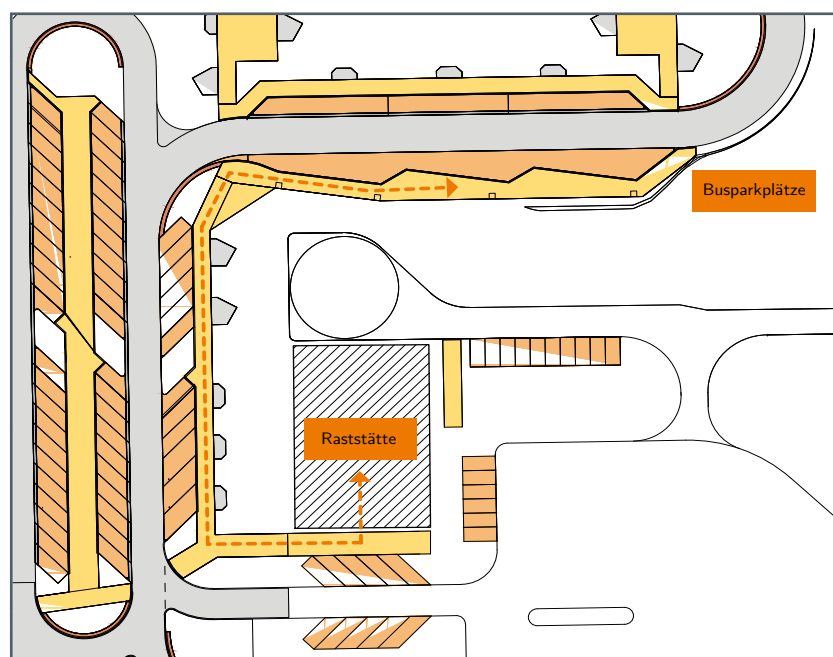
Rastanlage mit Busparkplätzen nahe der Raststätte (Ausschnitt Lageplan)
